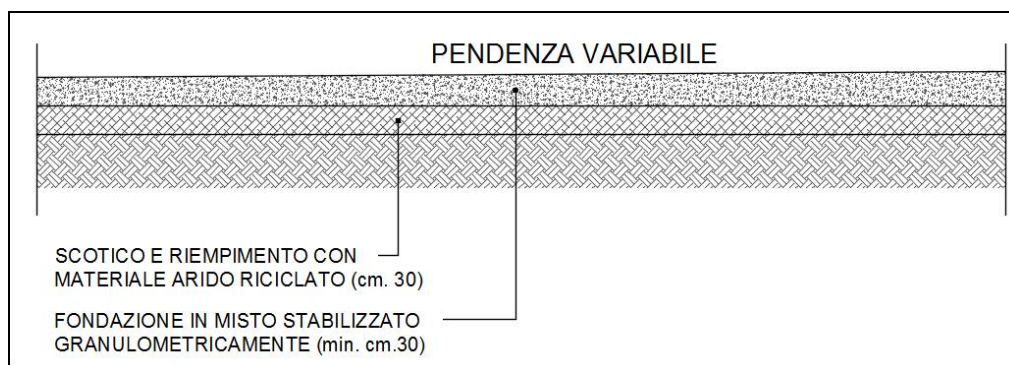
Schematizzazione delle tipologie di materiale impiegate per la realizzazione delle pavimentazioni in misto stabilizzato
